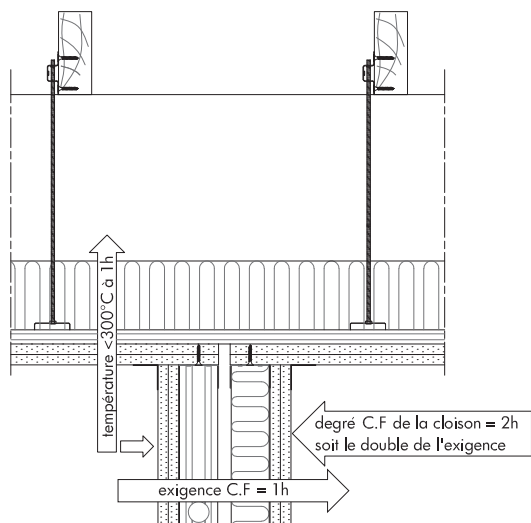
Cloisons fixées sous plafond - ERP type U
